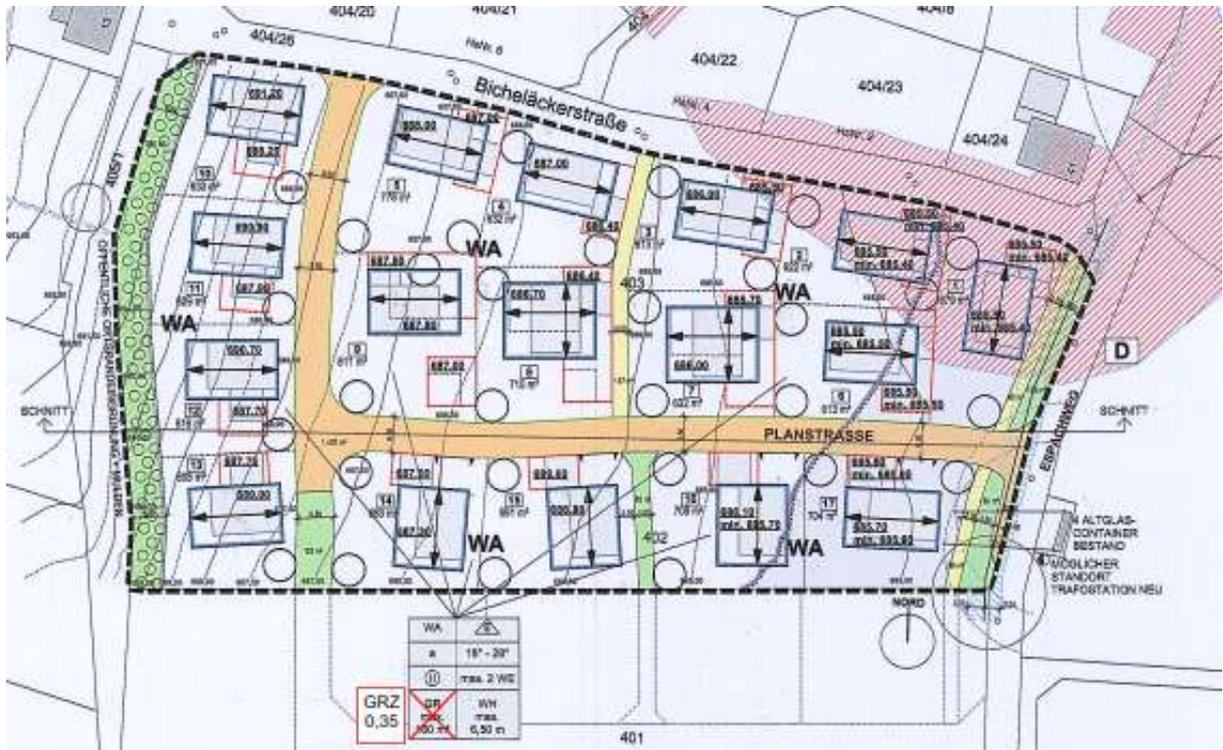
Ursprungsbebauungsplan "Bicheläcker II" einschließlich der 1. Änderung
